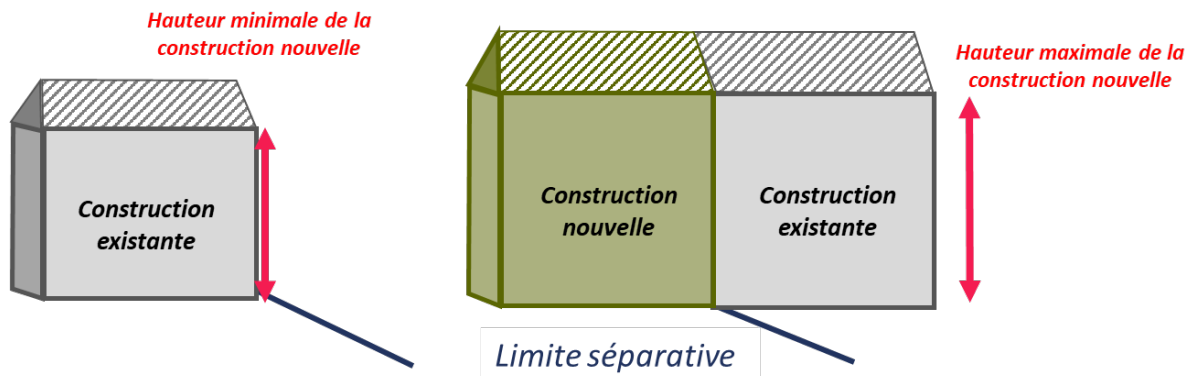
Règle de hauteur des constructions en ordre continu ou semi-continu en zone Ub
